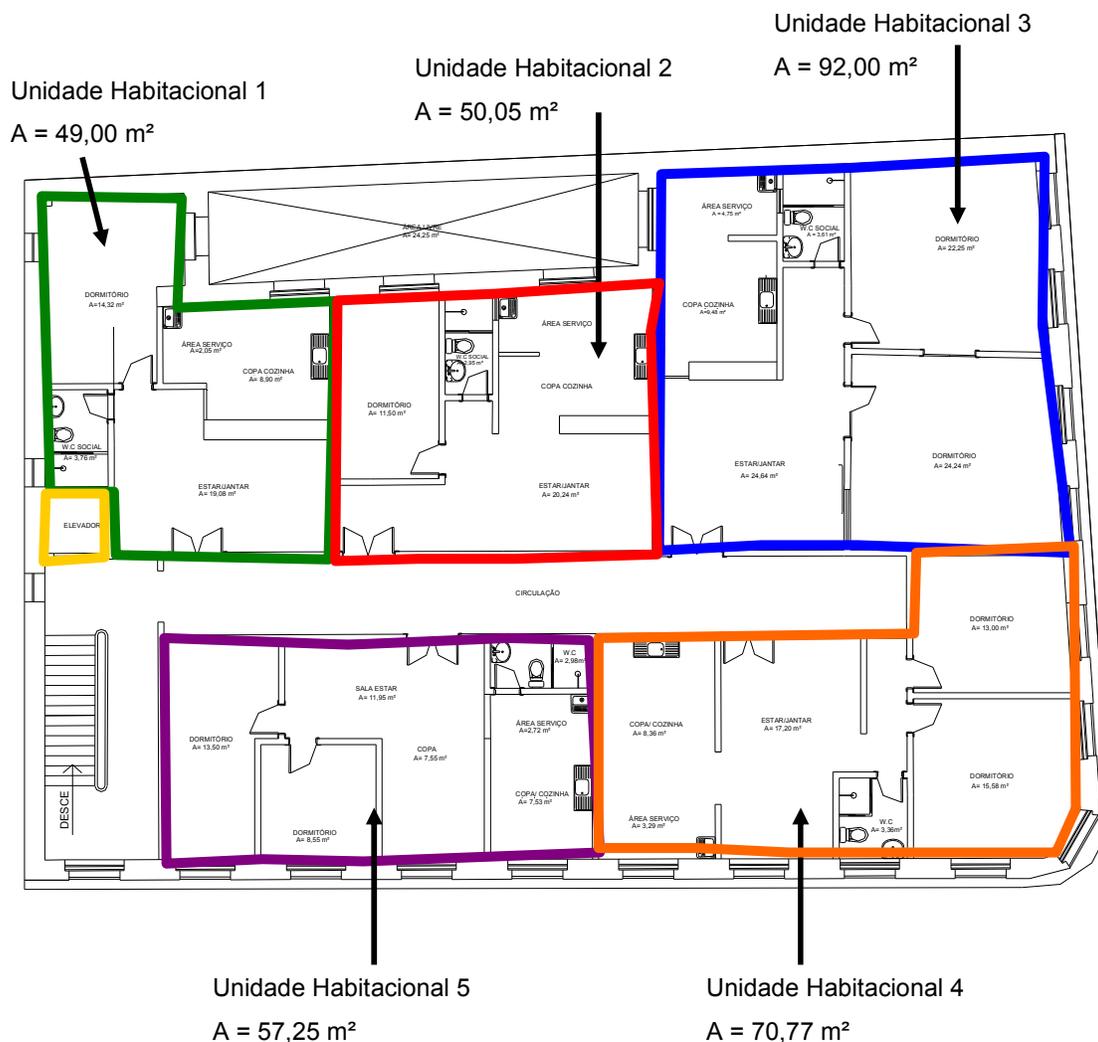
Planta baixa da proposta para o 1º pavimento do imóvel da Trav. Leão XIII, N° 55/Rua Santo Antônio 139/153.
